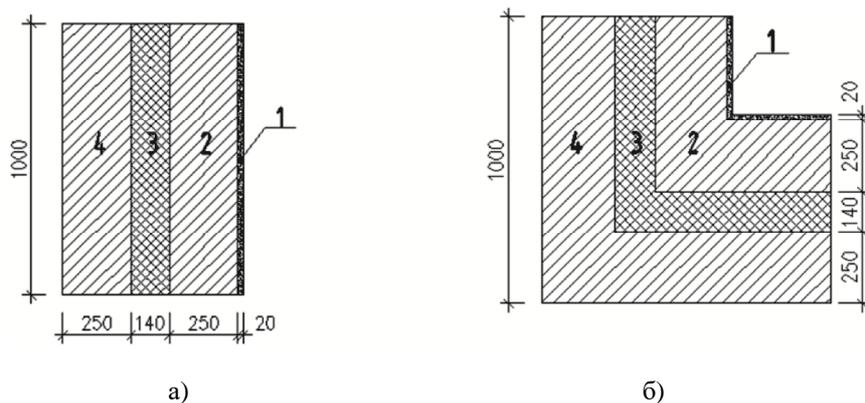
Расчетная схема конструкции: а) по глади стены, б) угловое сопряжение стены:
